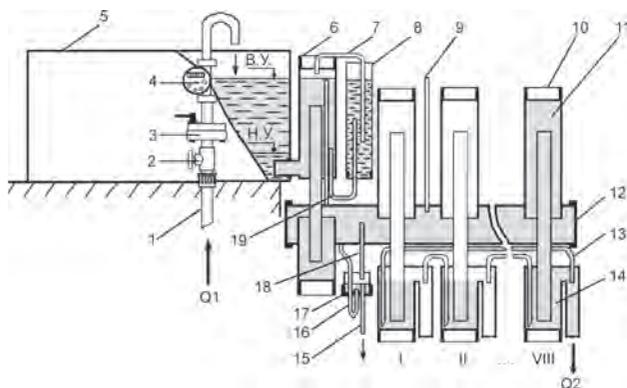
Принципиальная гидравлическая схема сифонного узла автоматического распределения водоподдачи:
